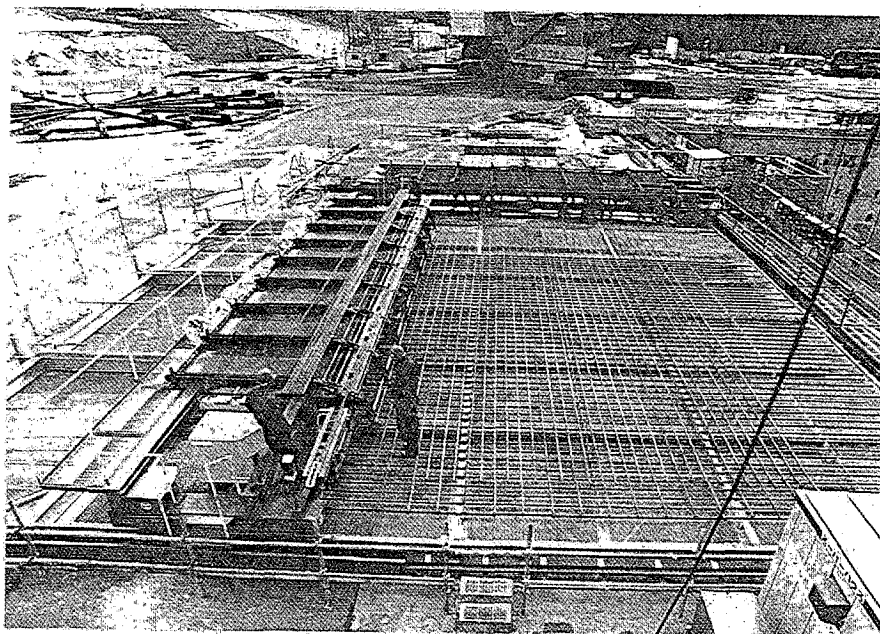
Sistema automatizado de prefabricación y colocación de armaduras
